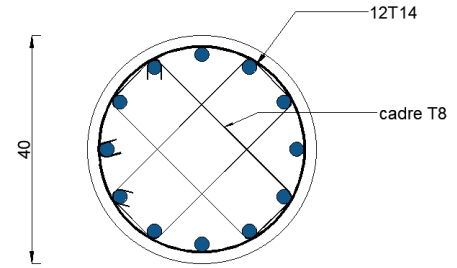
schéma de ferraillage des poteaux circulaires de 8^{me} et 9^{eme}
